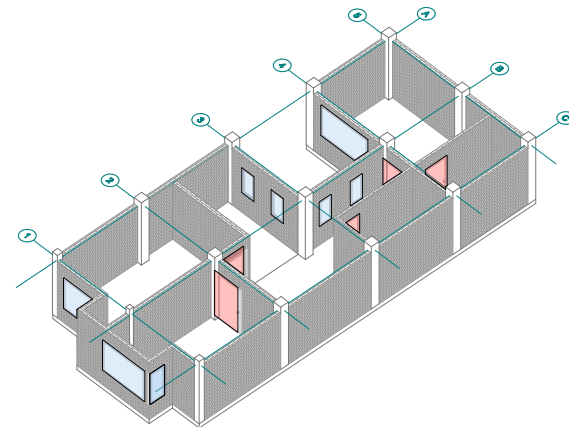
Aberturas verticales en paredes planta alta. Quinde & Salinas, 2019.
